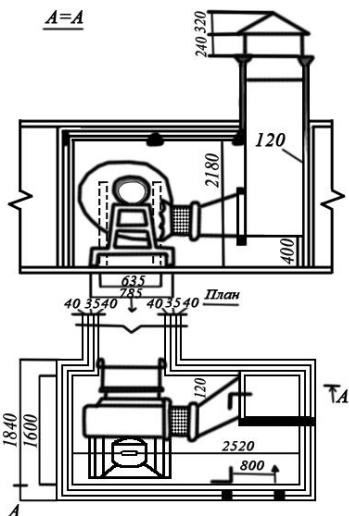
Припливна вентиляційна установка в приміщенні першого поверху будівлі:
